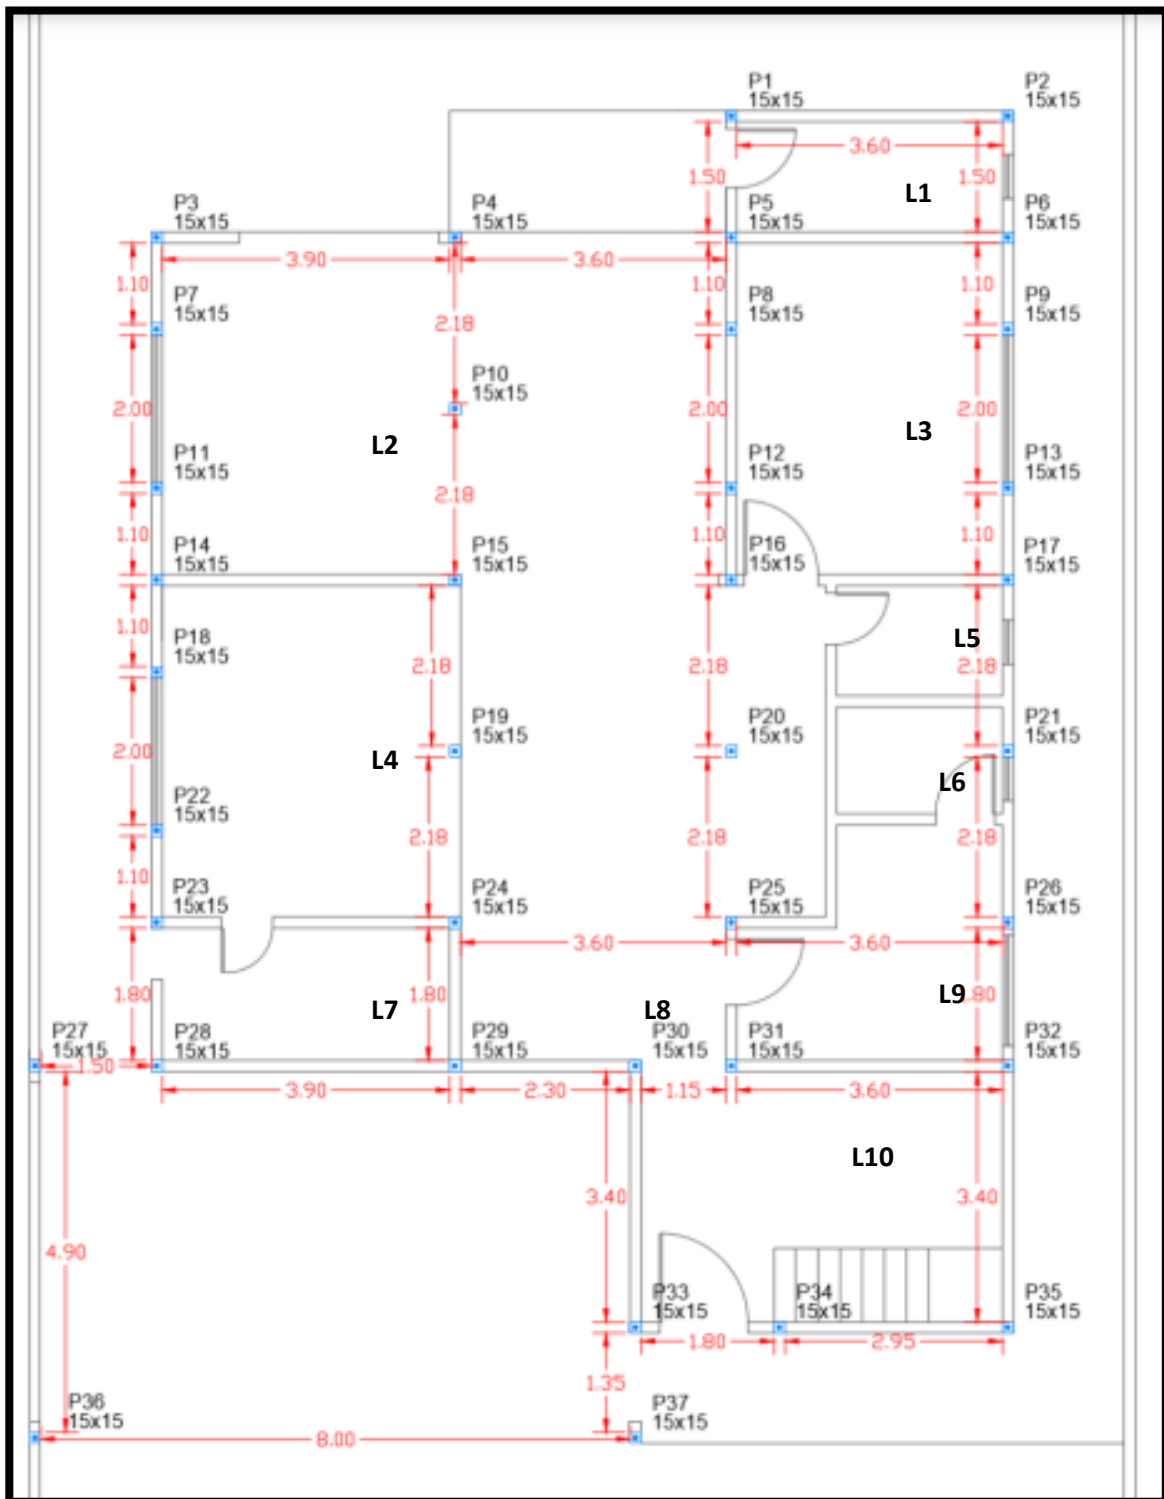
Planta 1º pavimento dimensões em Madeira
